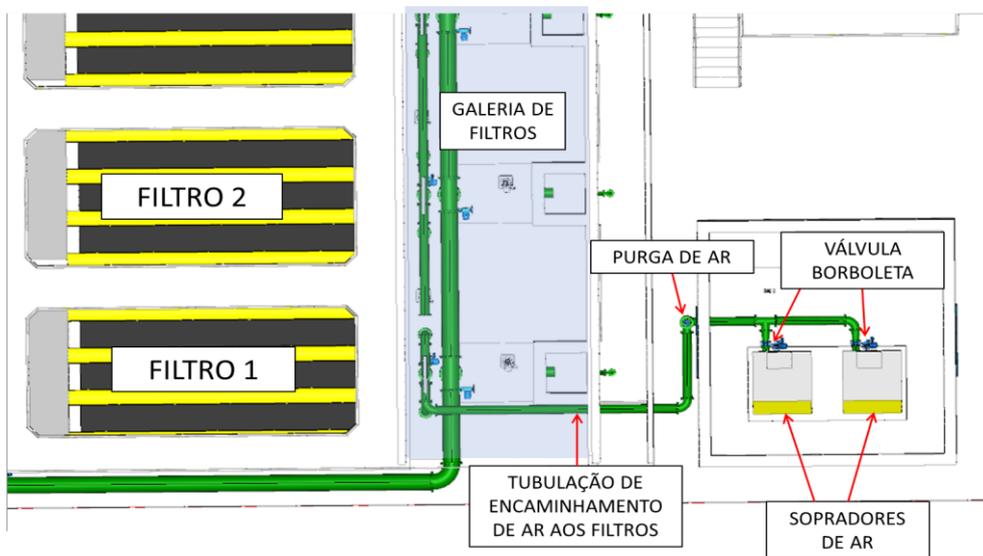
Vista em planta com indicação do local de instalação dos sopradores. Fonte: Arcadis (2022)
